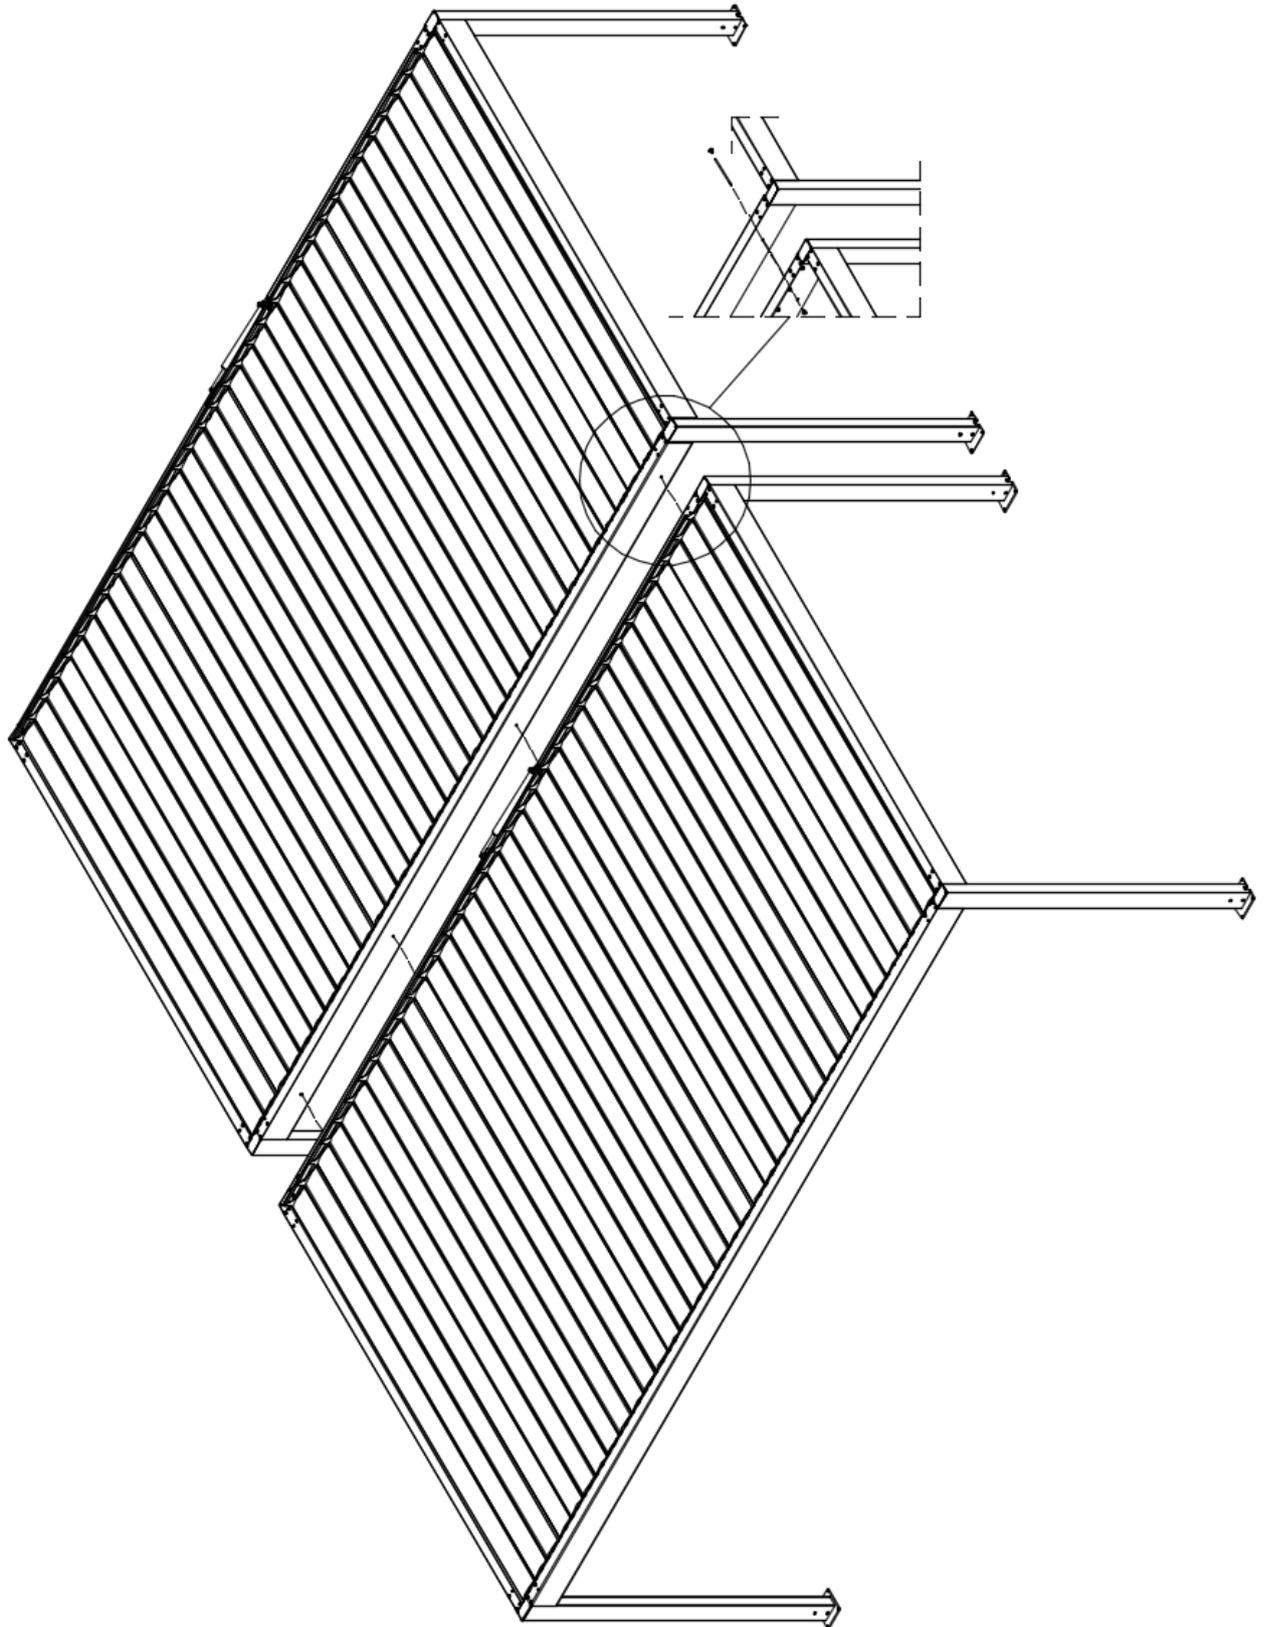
Vue de l'assemblage des modules de la Pergola SB 400
